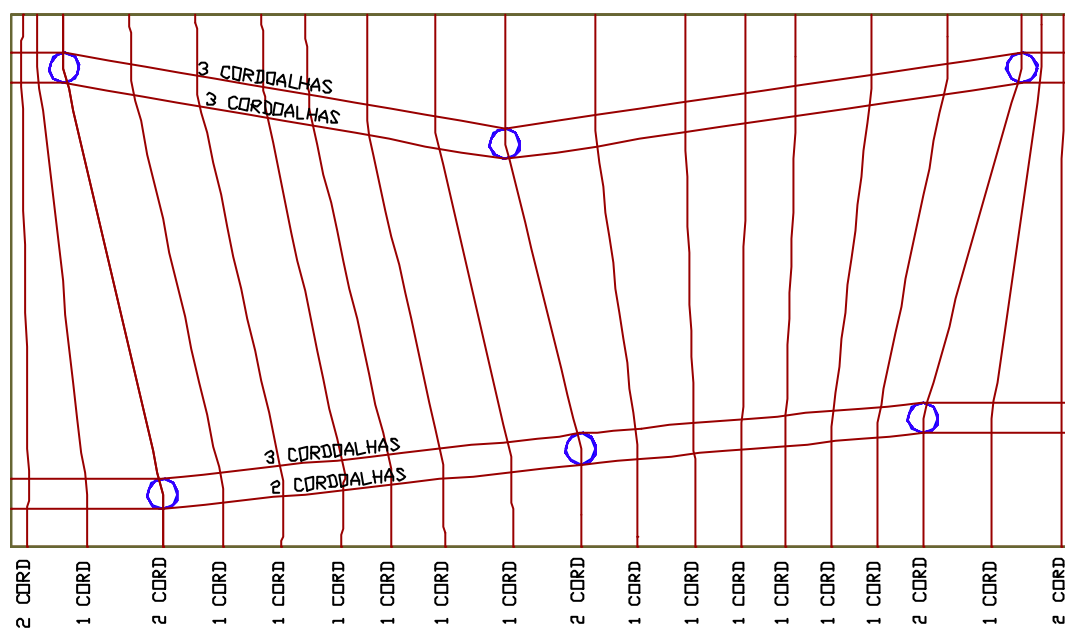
Vista em Planta da Disposição dos Cabos
